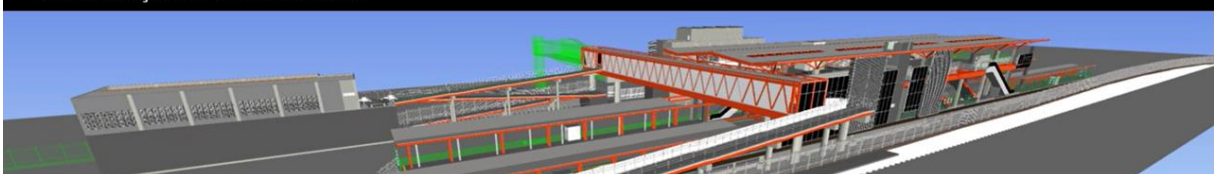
Fase 5 do projeto e da implantação da obra e transição para a Fase 6
